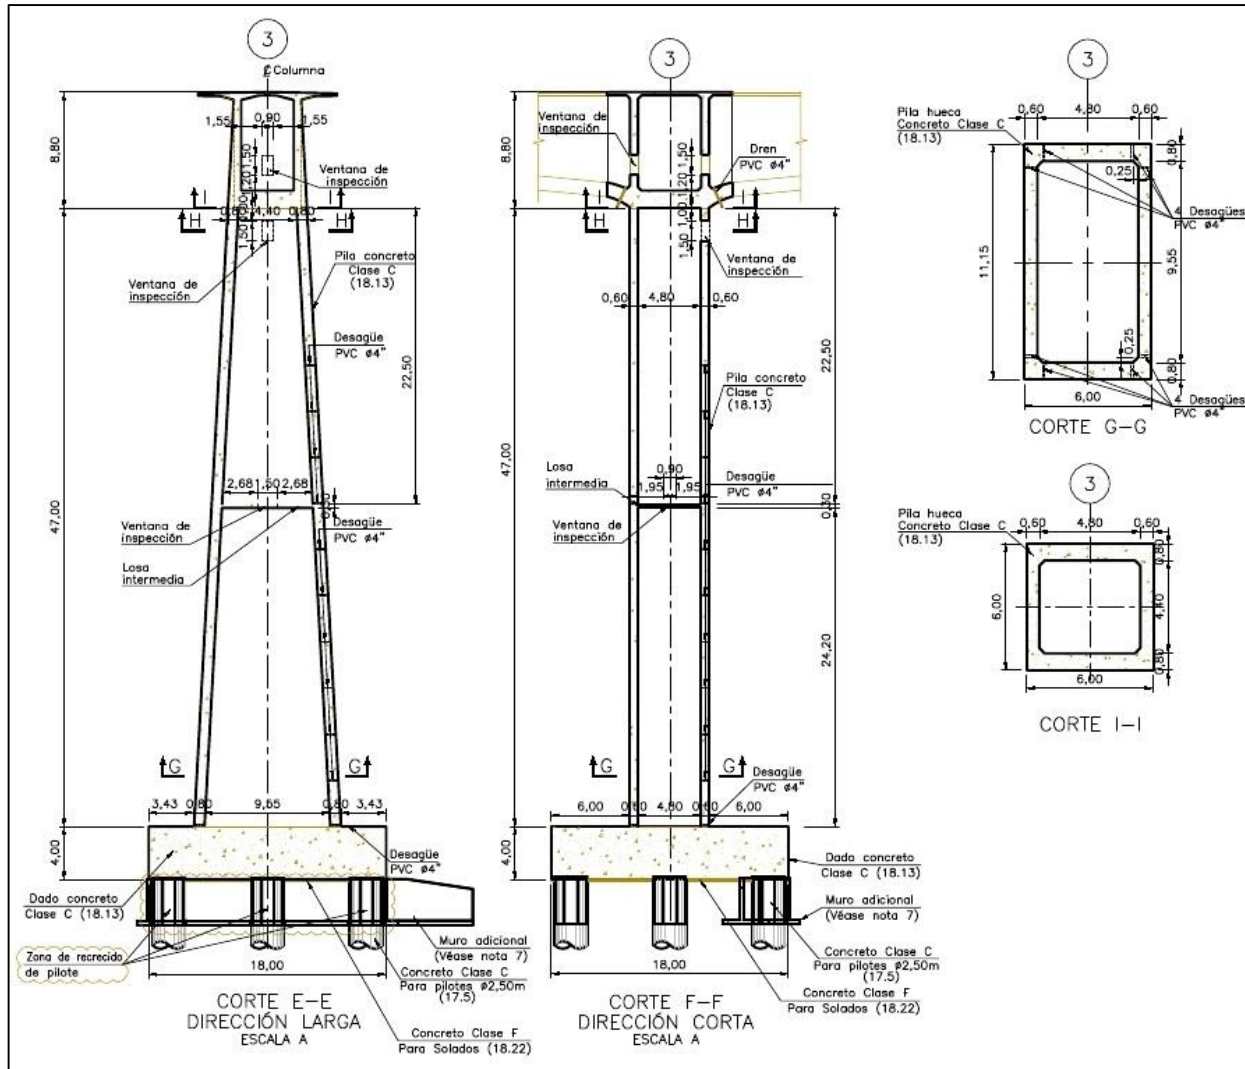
Perfil de las Pilas 2, 3 - Ejes 3, 4 respectivamente, en dirección longitudinal y transversal.
